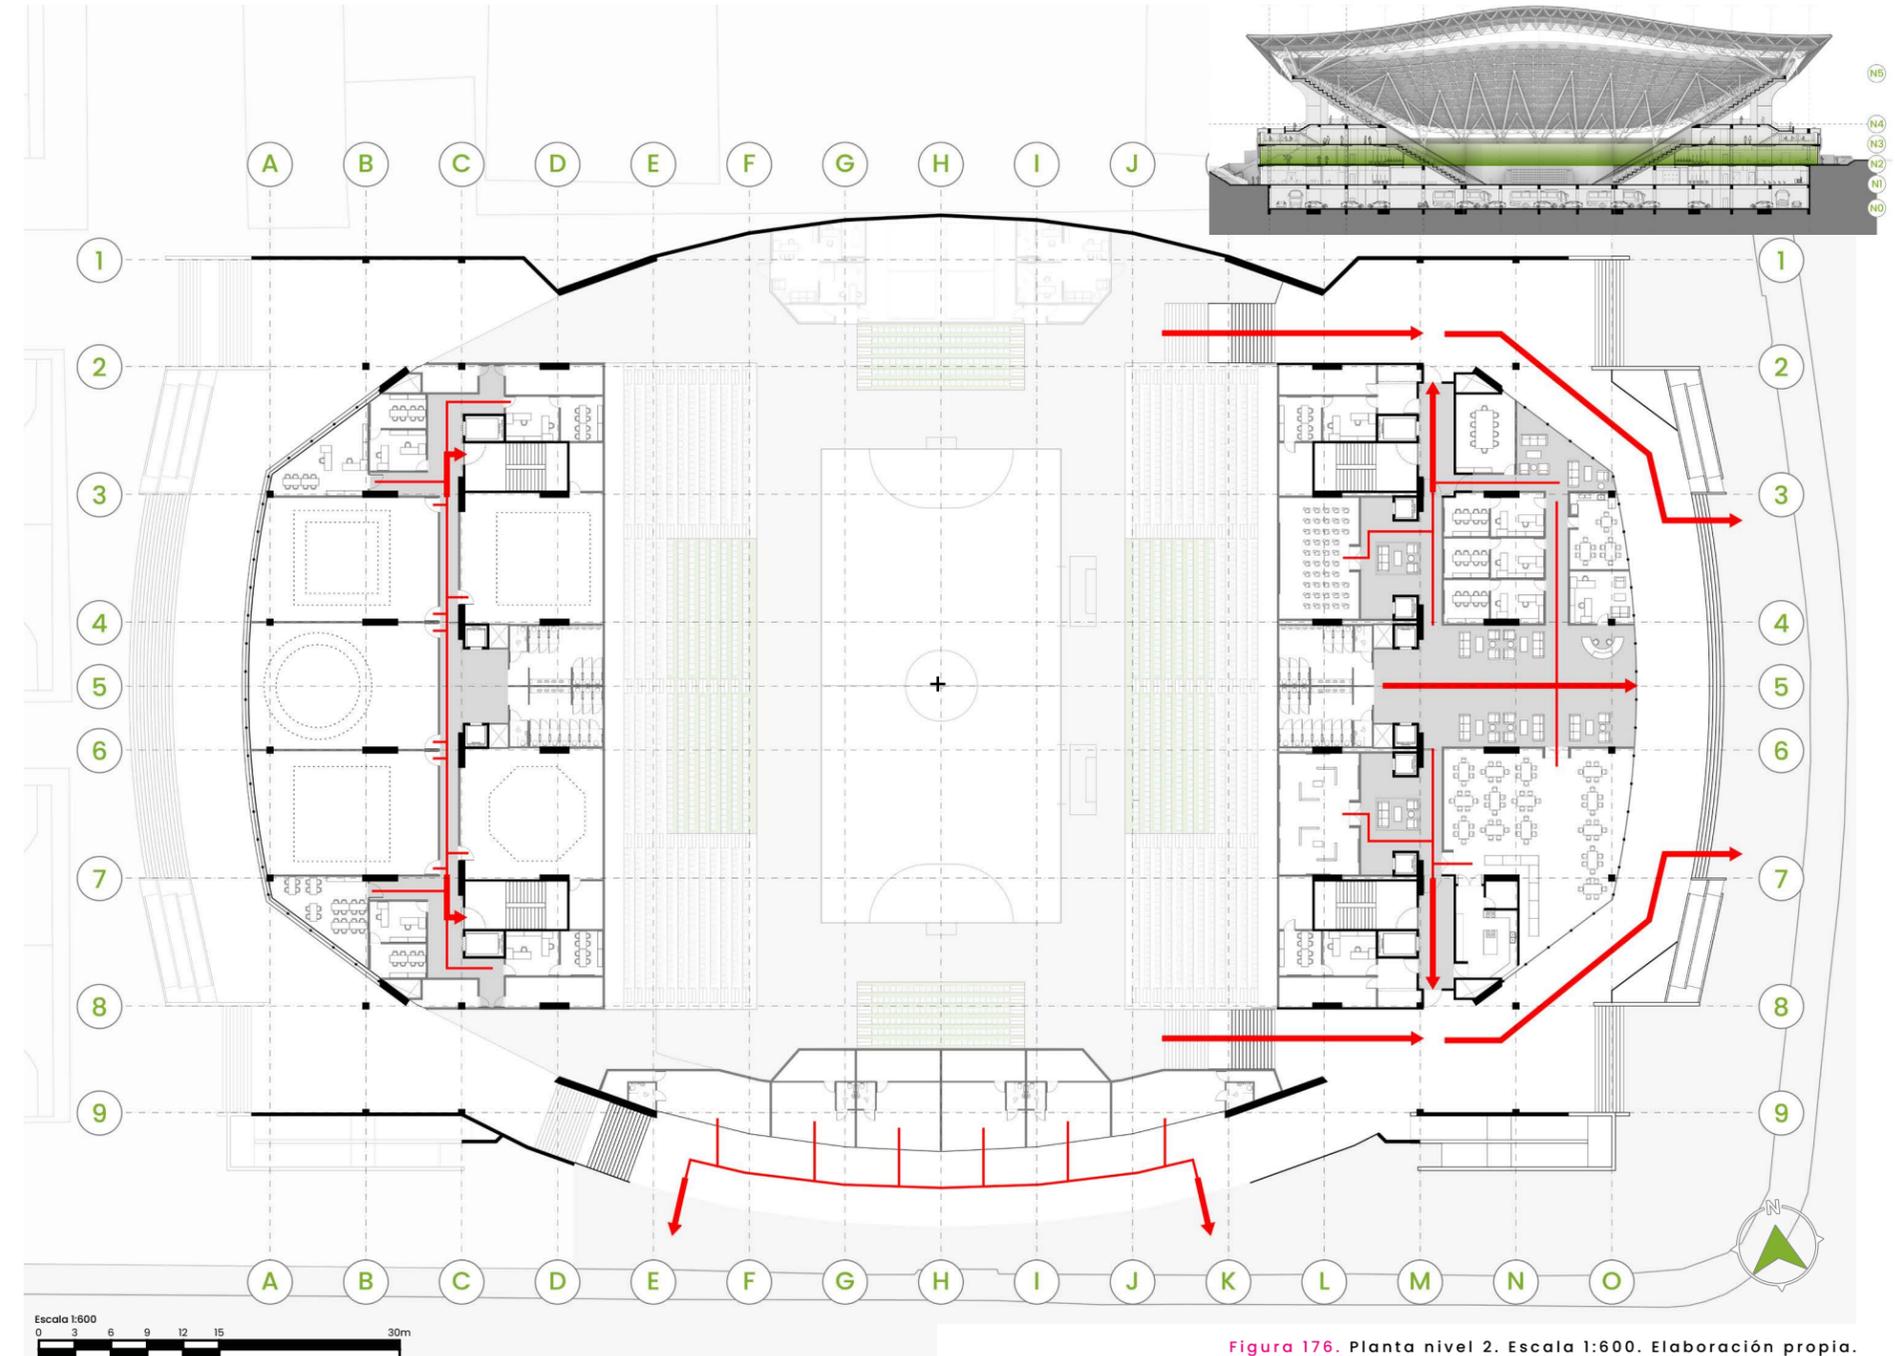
Planta nivel 2. Escala 1:600. Elaboración propia.
